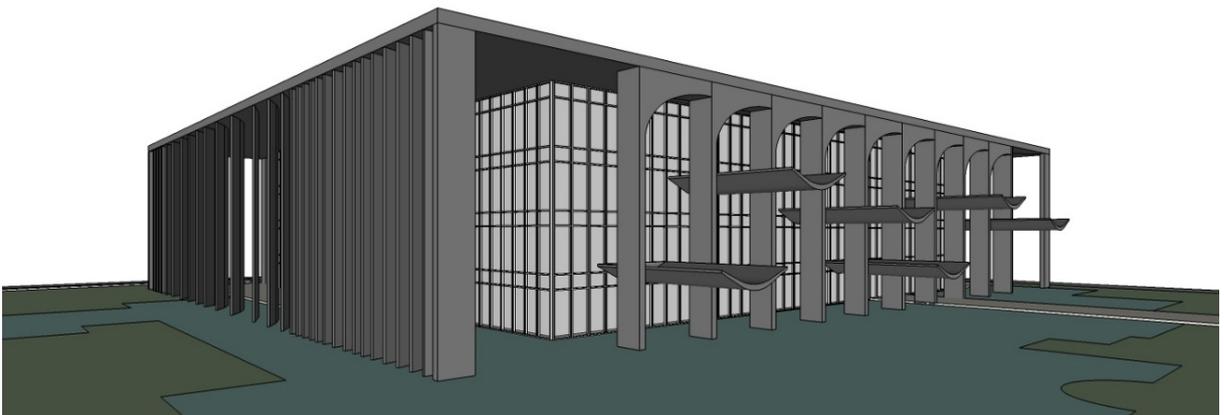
Perspectiva conceitual do Palácio da Justiça, vista sul, fachada principal.
